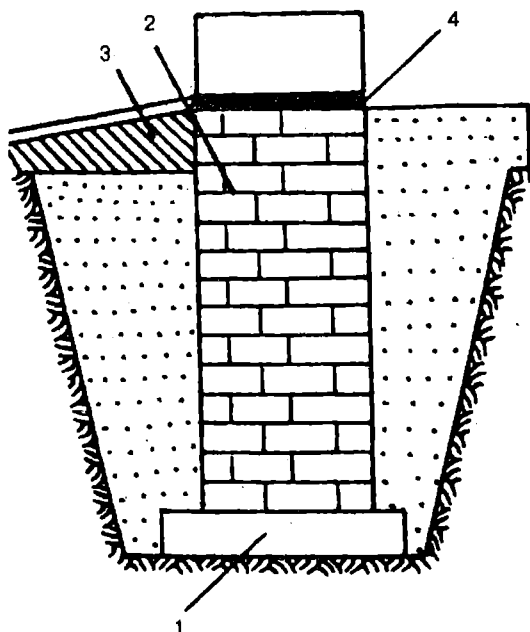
Фундаментный столб из обожженного красного кирпича:
